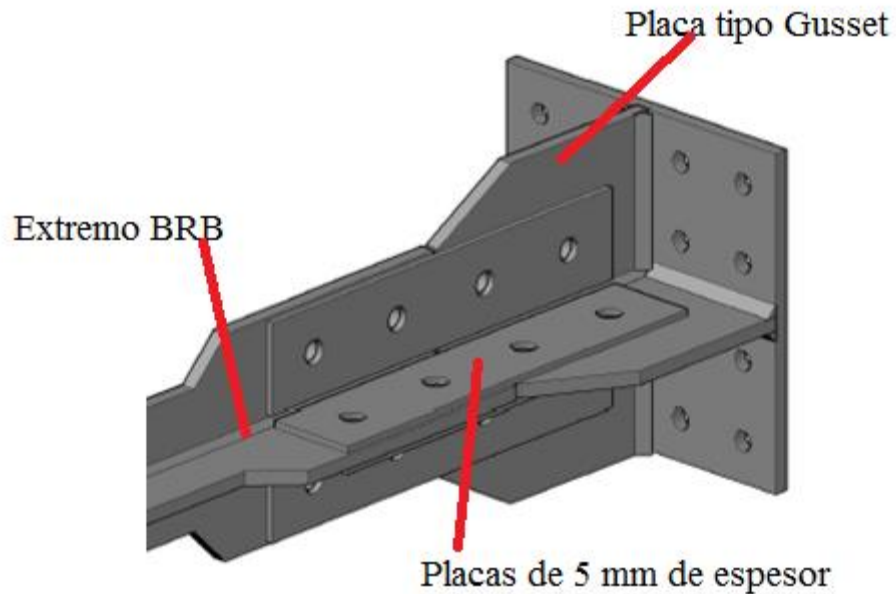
5 Conexión BRB - Placa Gusset - Apoyo.
